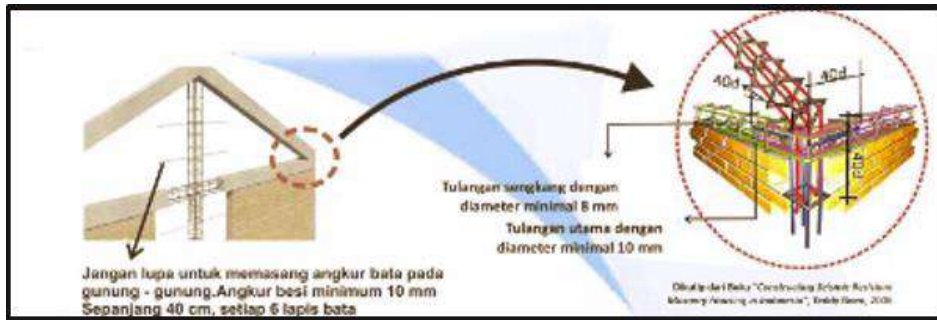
Struktur beton bertulang rumah aman bencana (PUPR – JICA)
